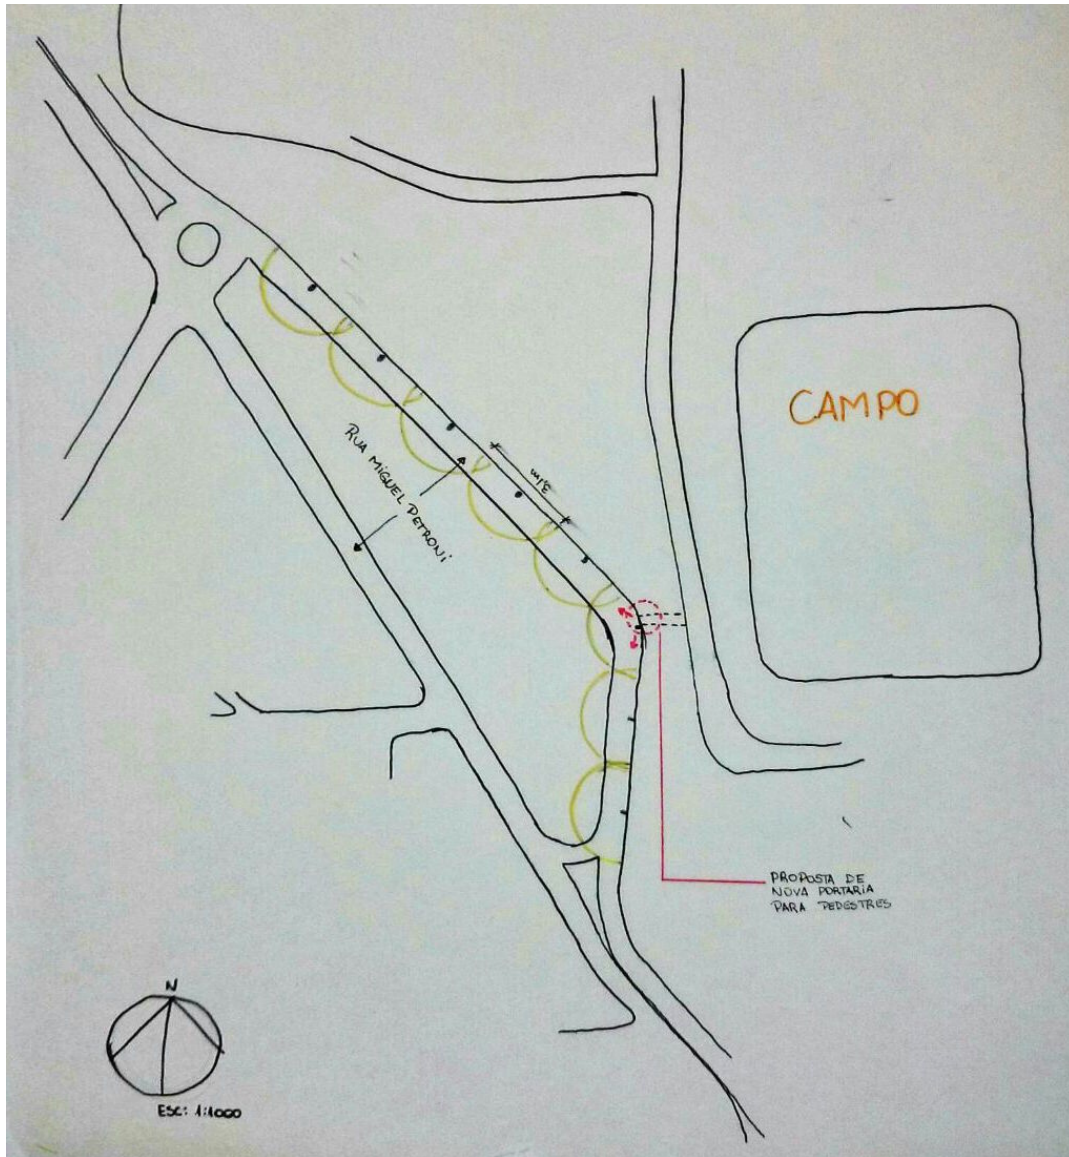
Implantação. Projeto de Iluminação para as calçadas adjacentes ao campus.
